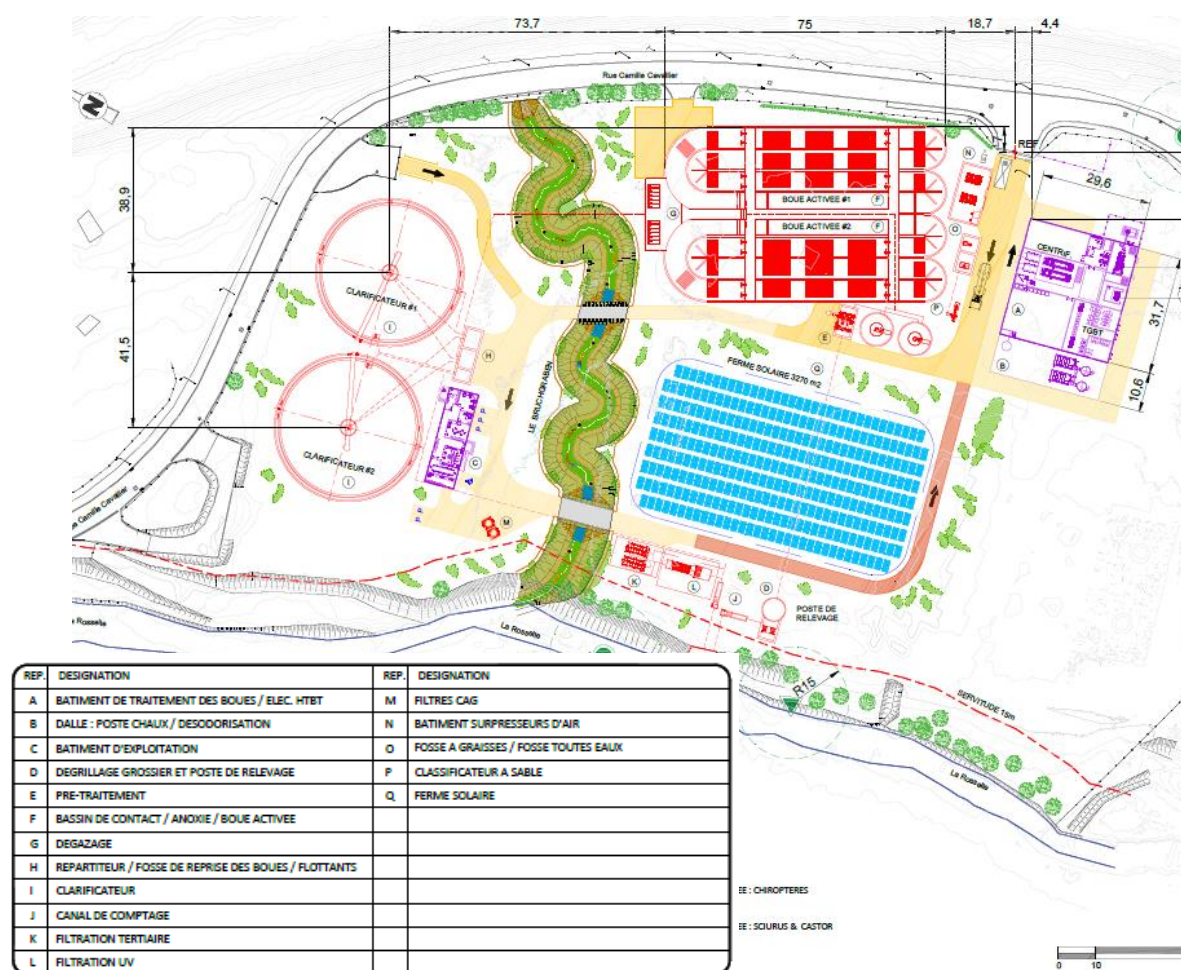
Plan masse au stade études préliminaires AMO EGIS de la future STEP et du projet de renaturation
